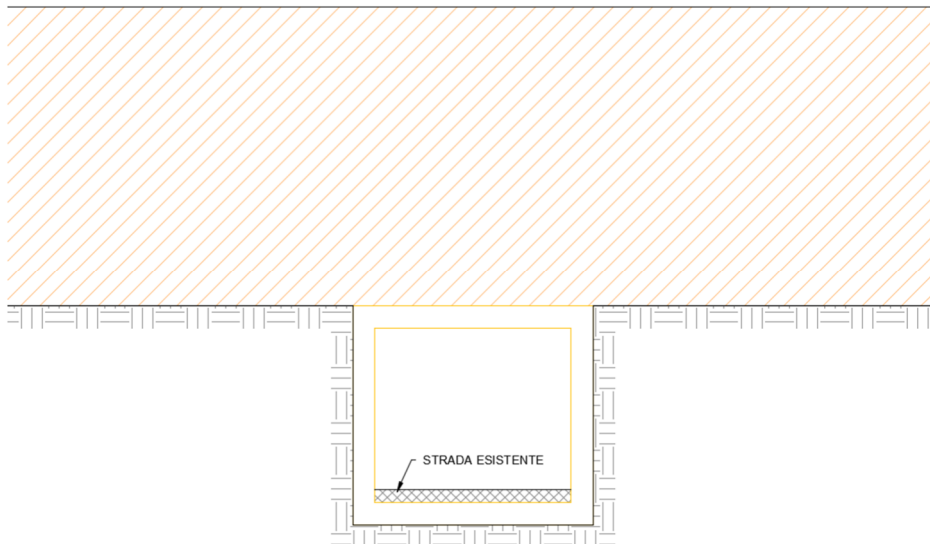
sezione trasversale ante – operam con indicate le demolizioni e la rimozione del rilevato
